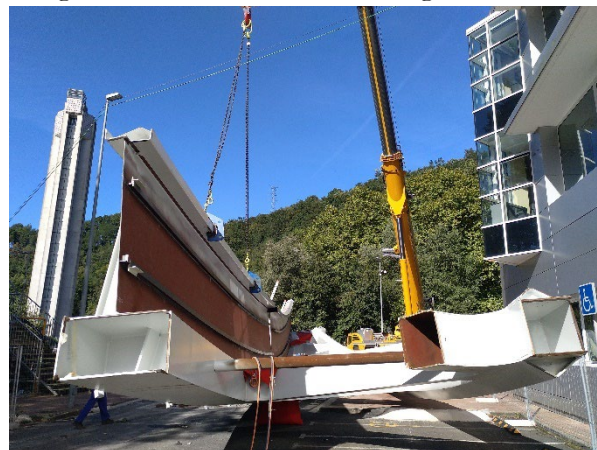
Celosía girada 90° para ensamble en obra de tramos de acero y viga de borde
